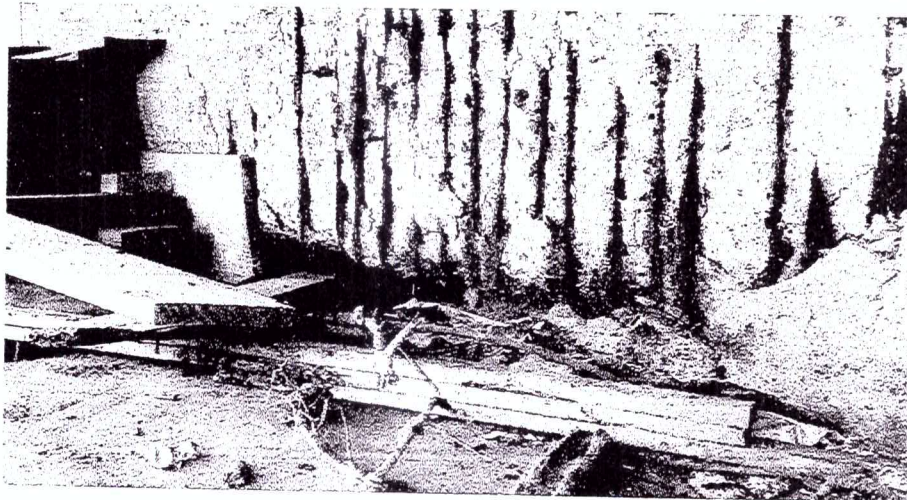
Longarinas junto aos apoios com corrosão acentuada de armaduras
